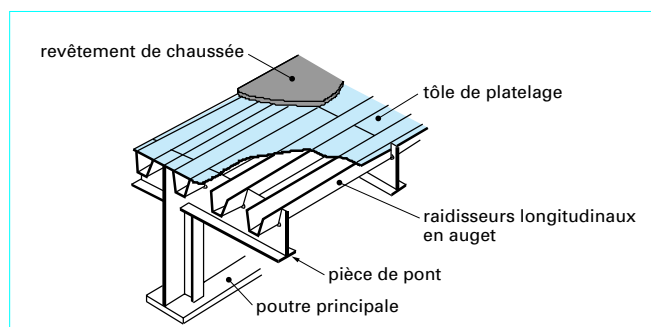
Tablier à platelage orthotrope et poutres à âme pleine
